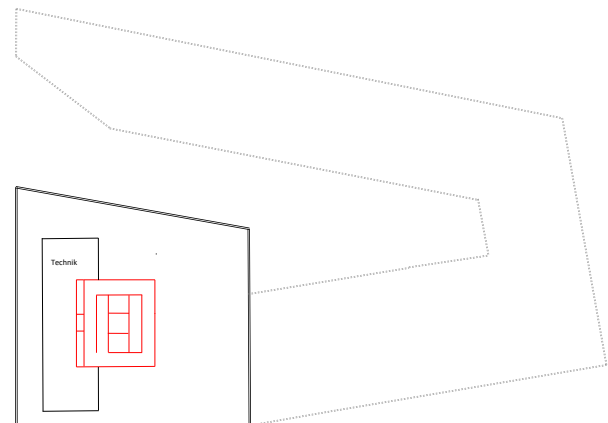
Grundriss Beispiellobjekt E+20
